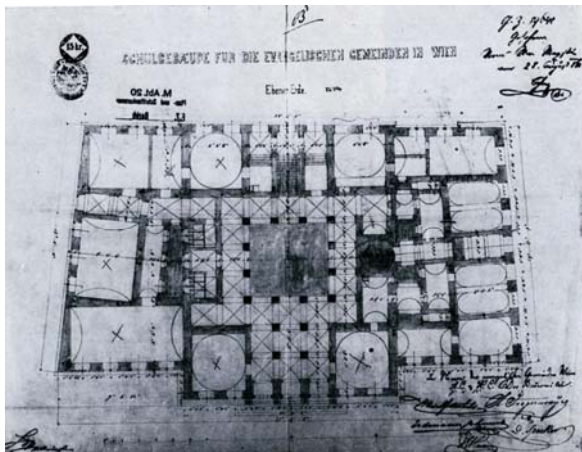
Grundrissentwurf zur Evangelischen Schule, Wien, 1860
